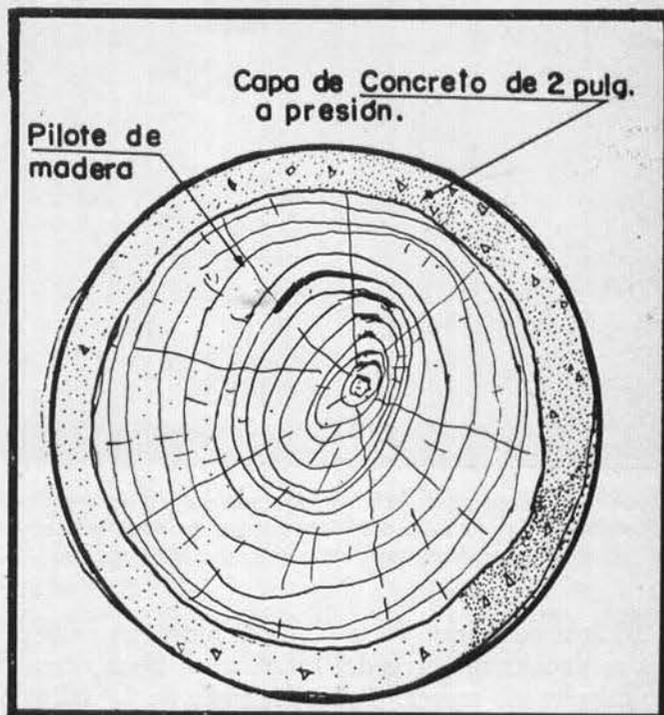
Sección transversal de un pilote tratado con concreto a presión.
